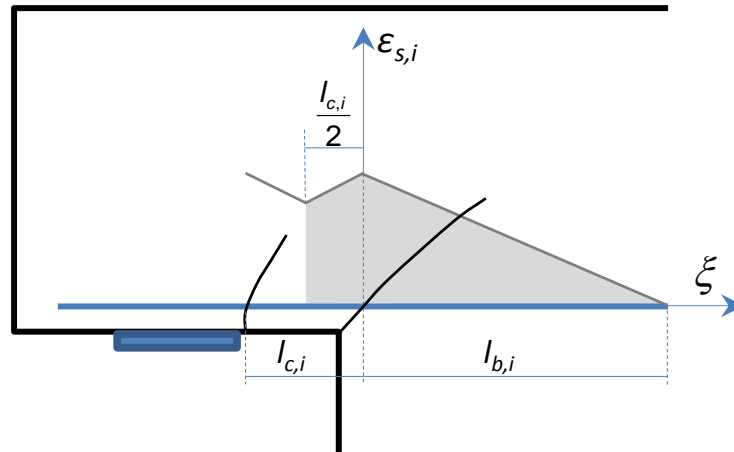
Anclaje de armaduras y aparición de fisuras adyacentes
